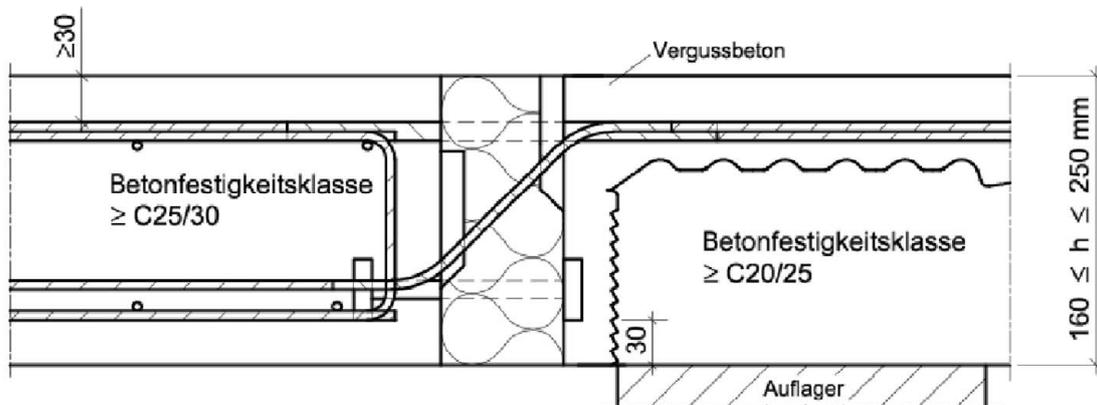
Schöck Isokorb® Typ Q-ID mit
